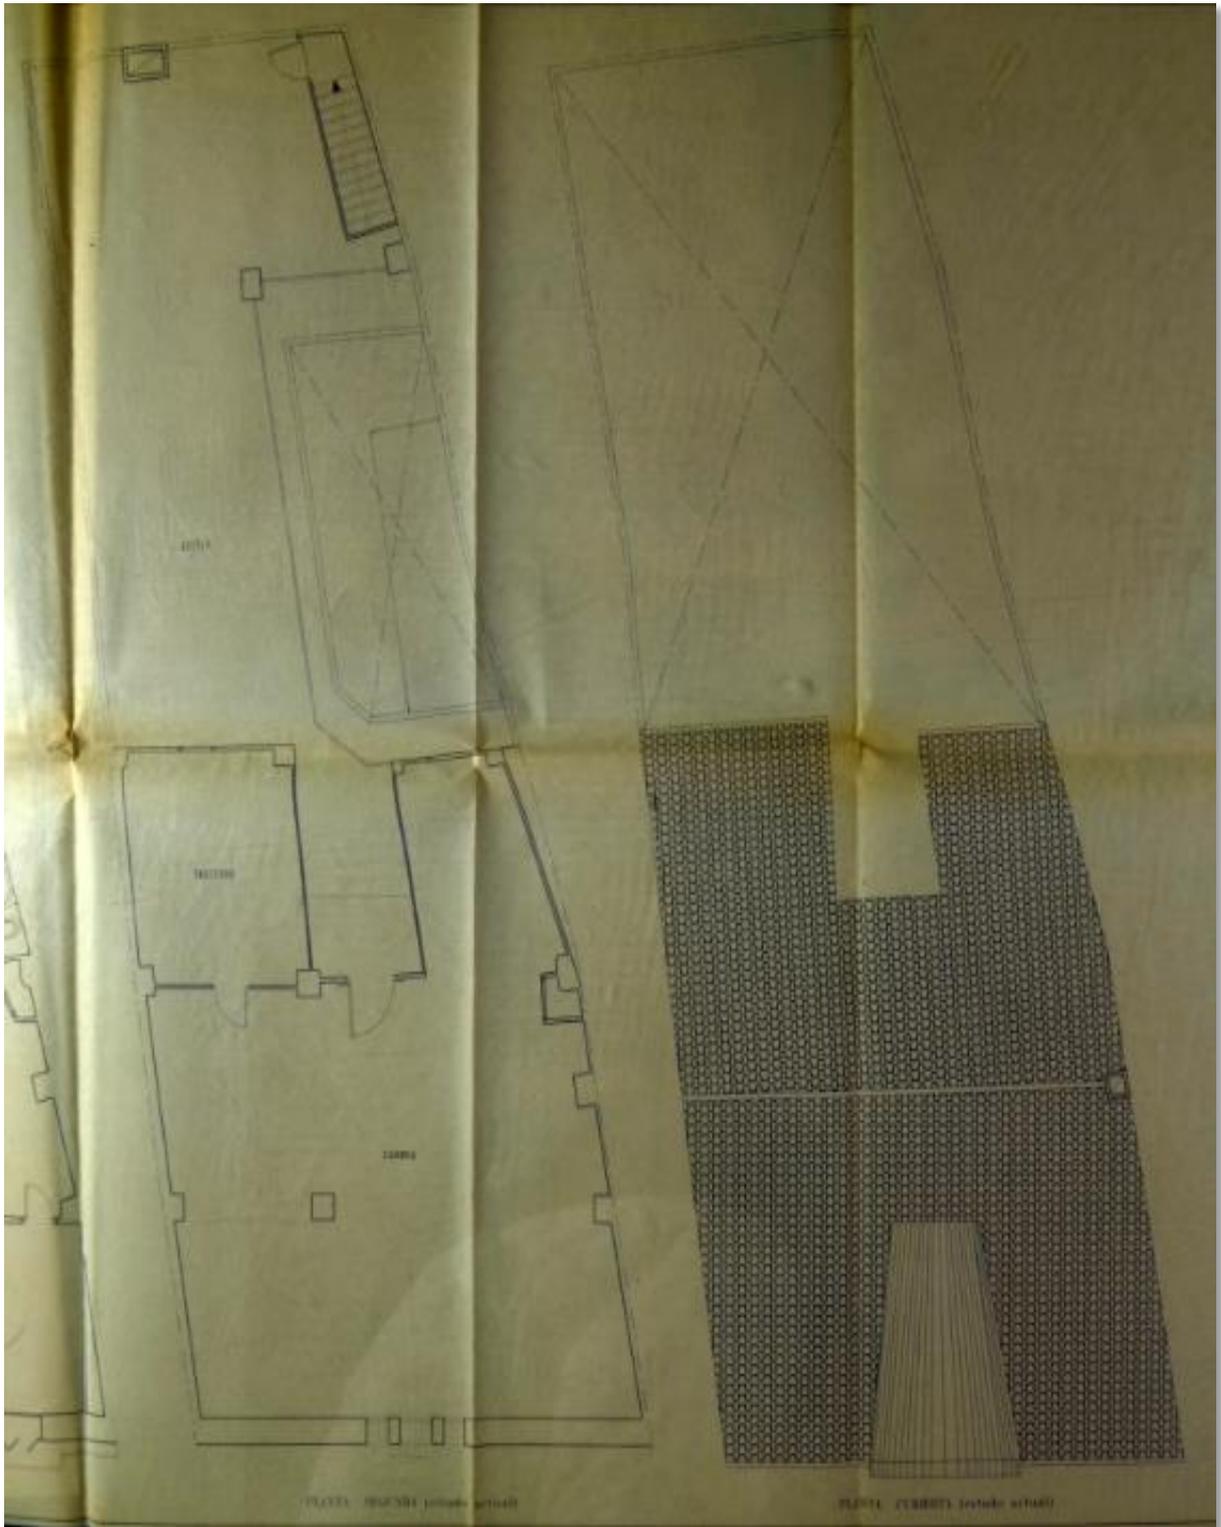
Plano de planta segunda y planta cubierta. Estado 1948.
